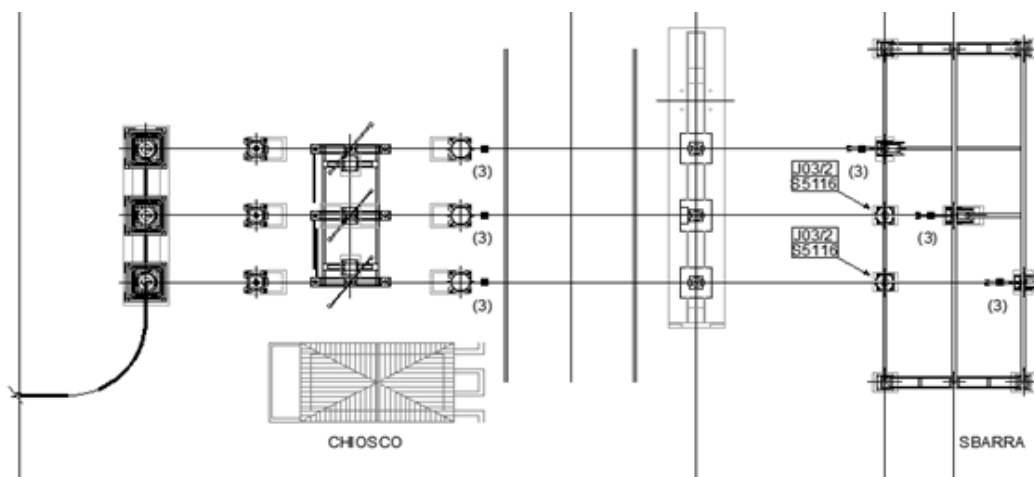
Planimetria elettromeccanica tipologica stallo di consegna TERNA
